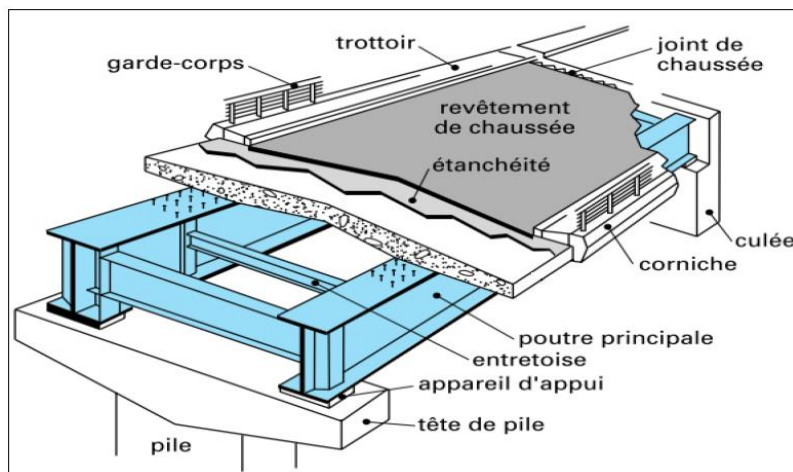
Coupe schématique d'un tablier mixte (bipoutre a entretoise)
